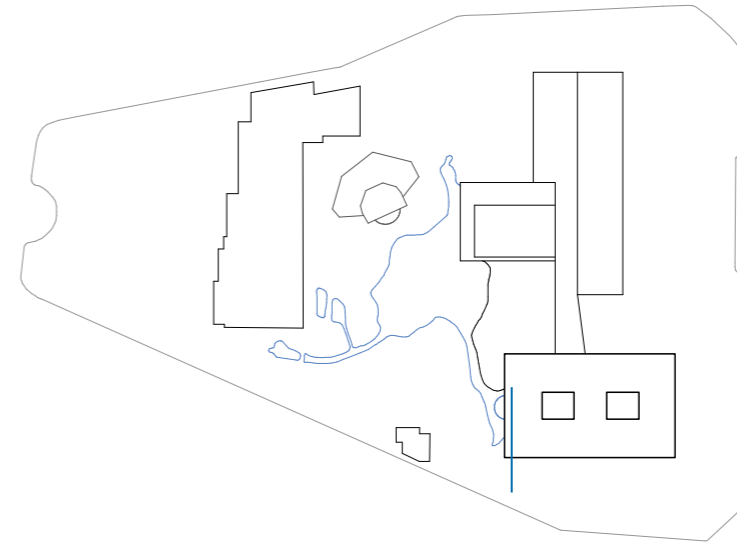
Síntese da planta de implantação, com foco no edifício do Museu Calouste Gulbenkian onde se insere a Biblioteca da Fundação.
